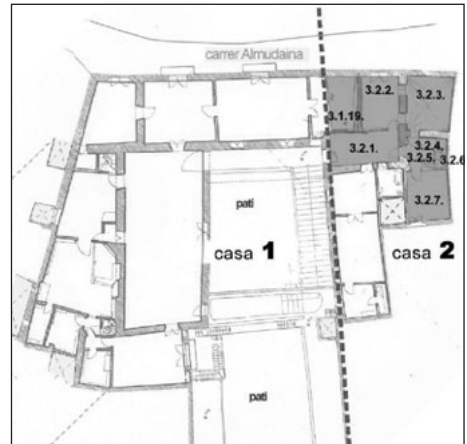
Planta noble del edificio actual. La zona sombreada señala el área de la casa 2 donde encuentra el pavimento de azulejos vidriados.
